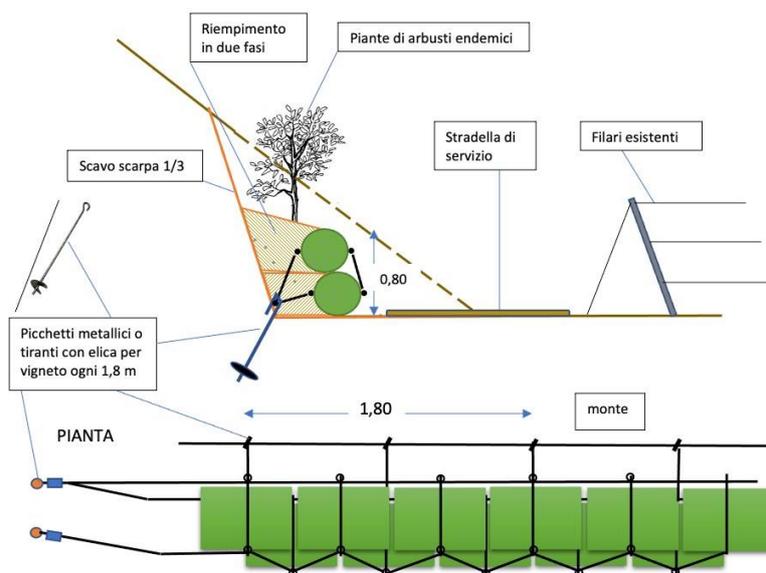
Schema di sezione tipo e pianta prototipo A2.
